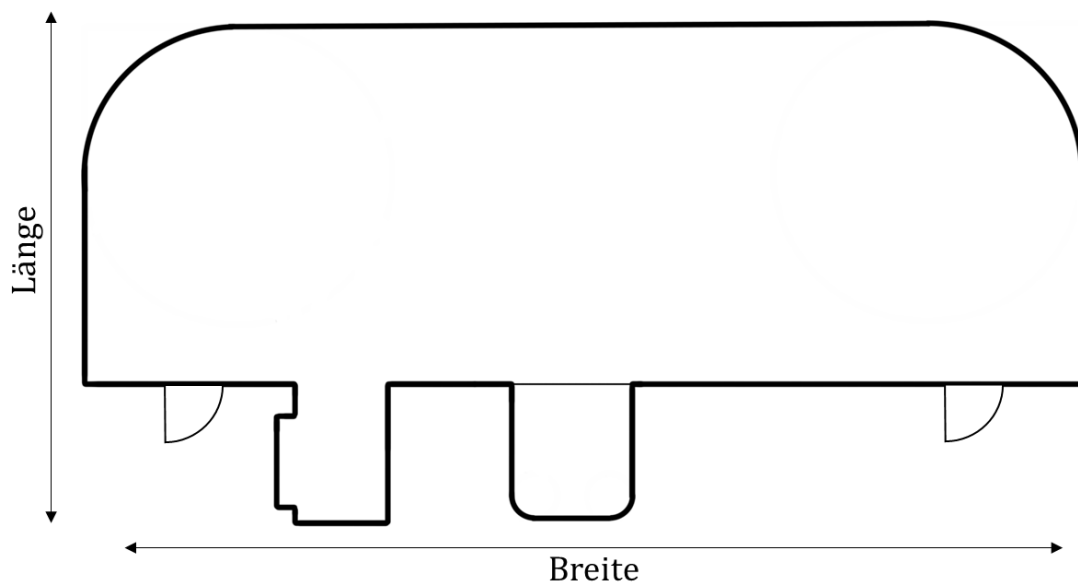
Grundriss des Ausstellungsraums „Musikinstrumente“ des Technischen Museums Wien
